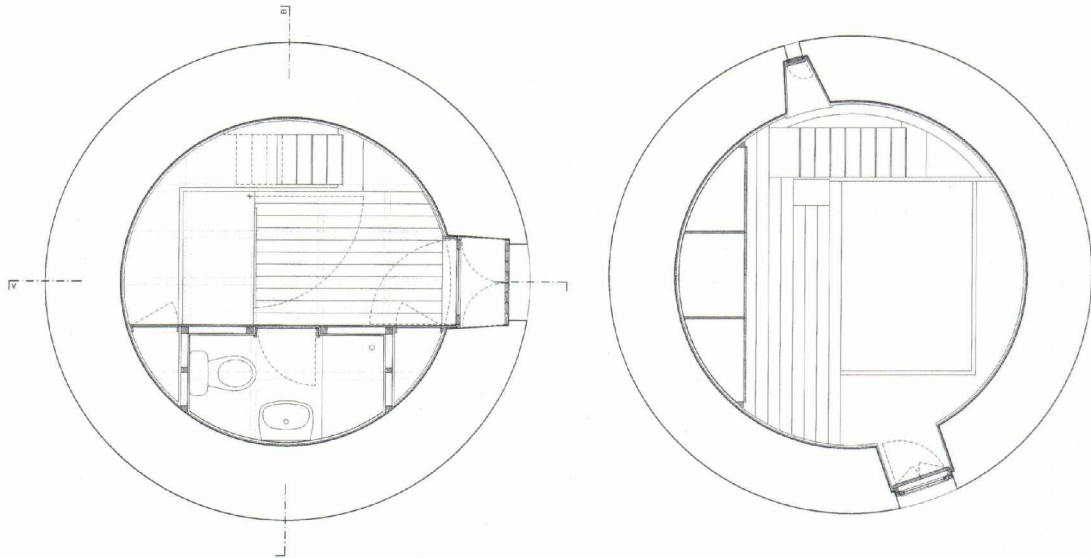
PLANTAS ARQUITECTÓNICAS
